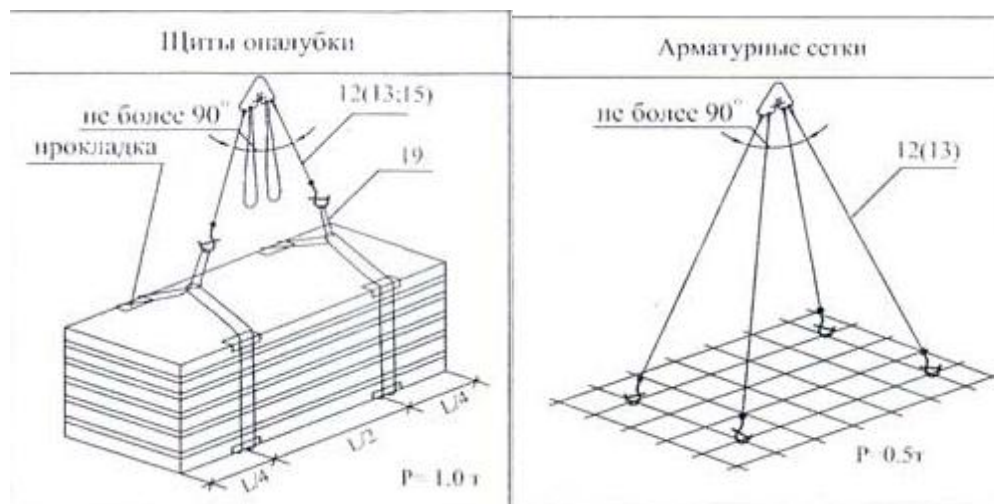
Схемы строповки щитов опалубки и арматурных сеток
